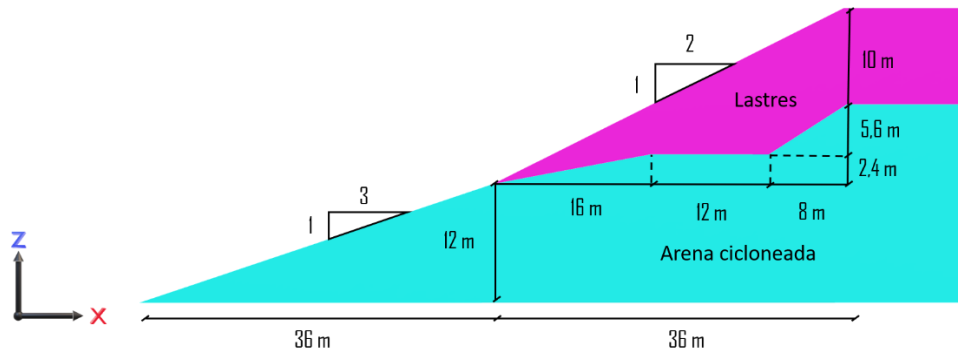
Detalle del perfil transversal del muro aguas abajo.
